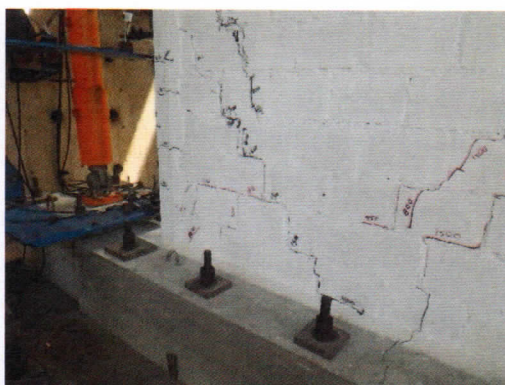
Formación de grietas diagonales en la parte inferior Oeste de la cara Sur para una distorsión de 1/550.
